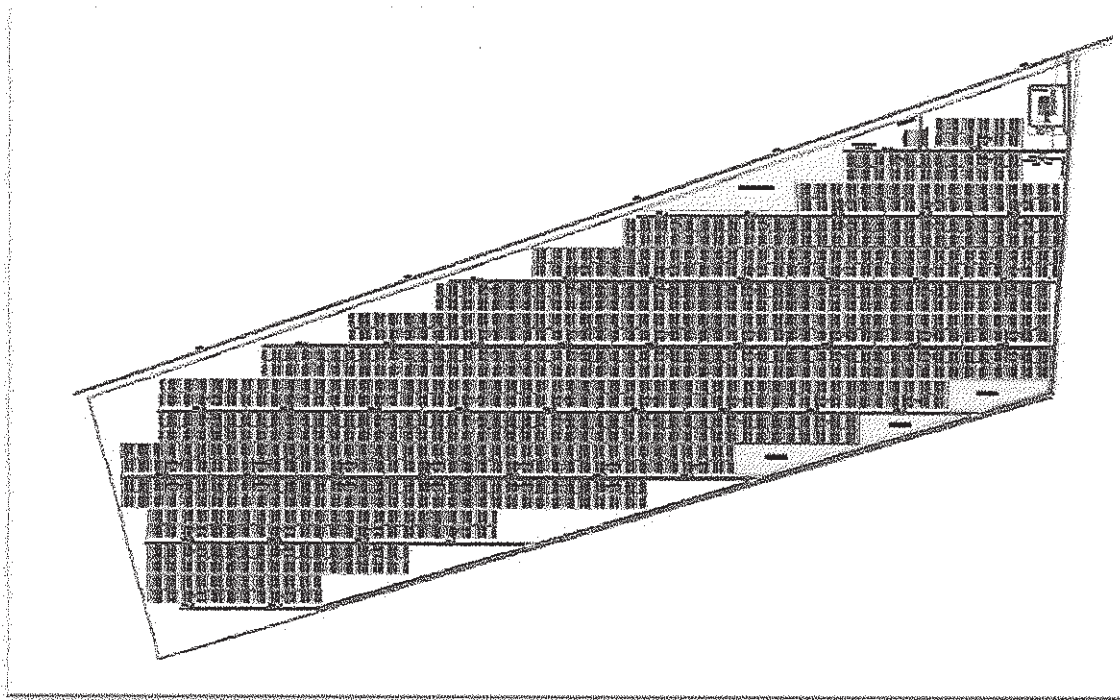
Plano de disposición de la Planta "Proyecto Solar Iglesia – Estancia Guañizuil".
